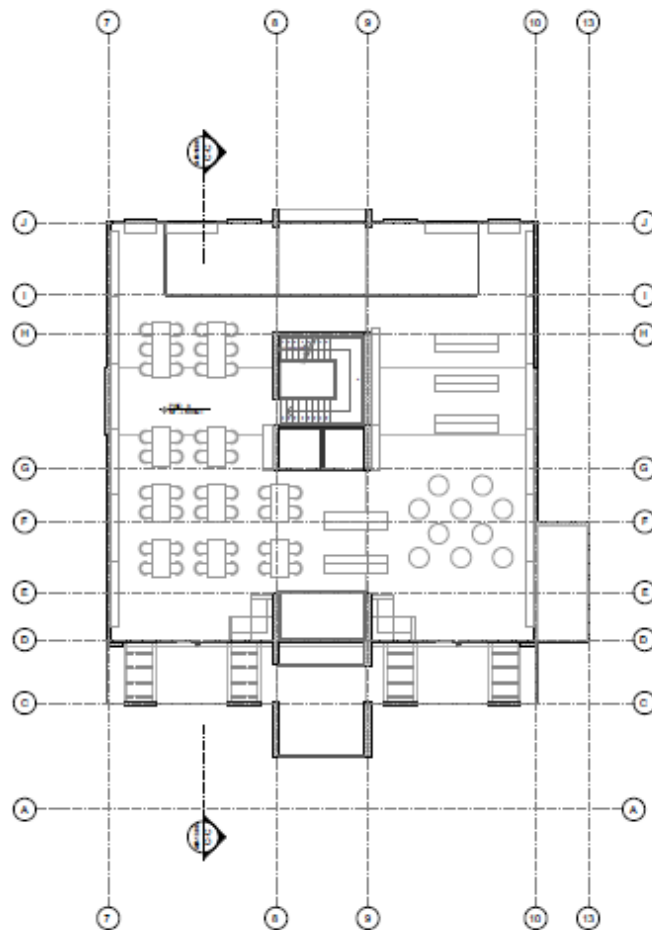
Planta arquitectónica tercer piso Centro cultural Fuente: propia
